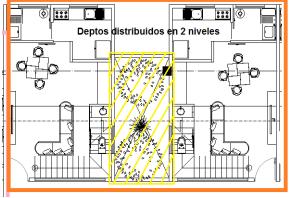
Ubicación de cubo de luz y de instalaciones en departamentos tipo de doble planta.
